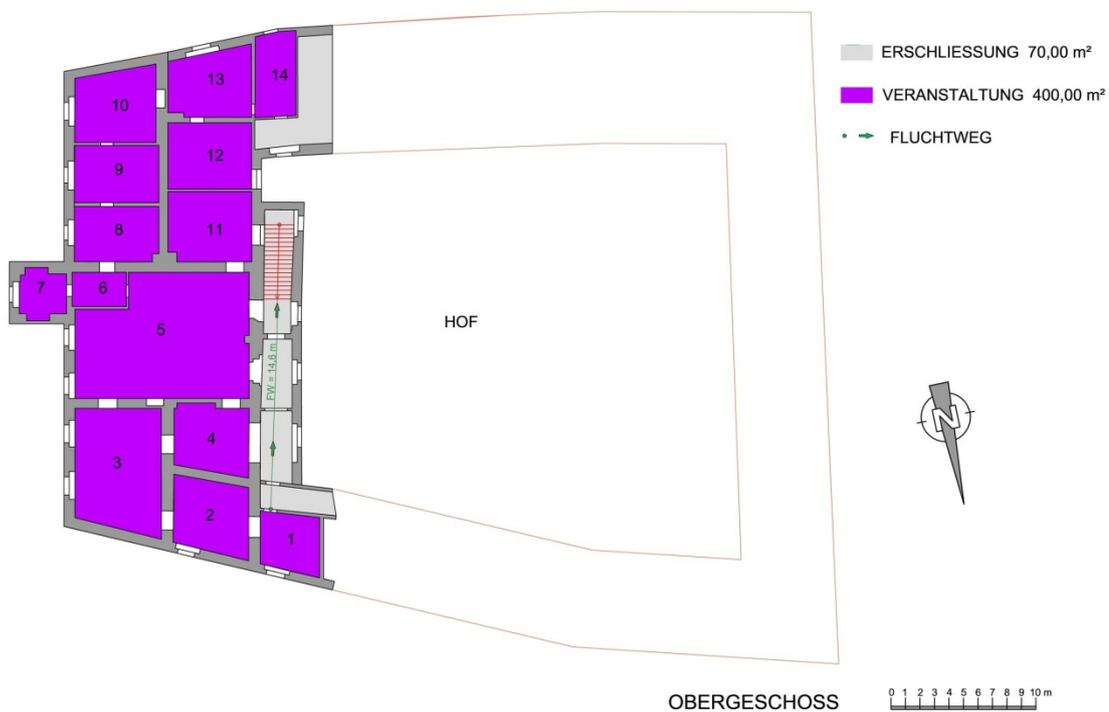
zeigt den Grundriss des Schlosses Jedenspeigen
